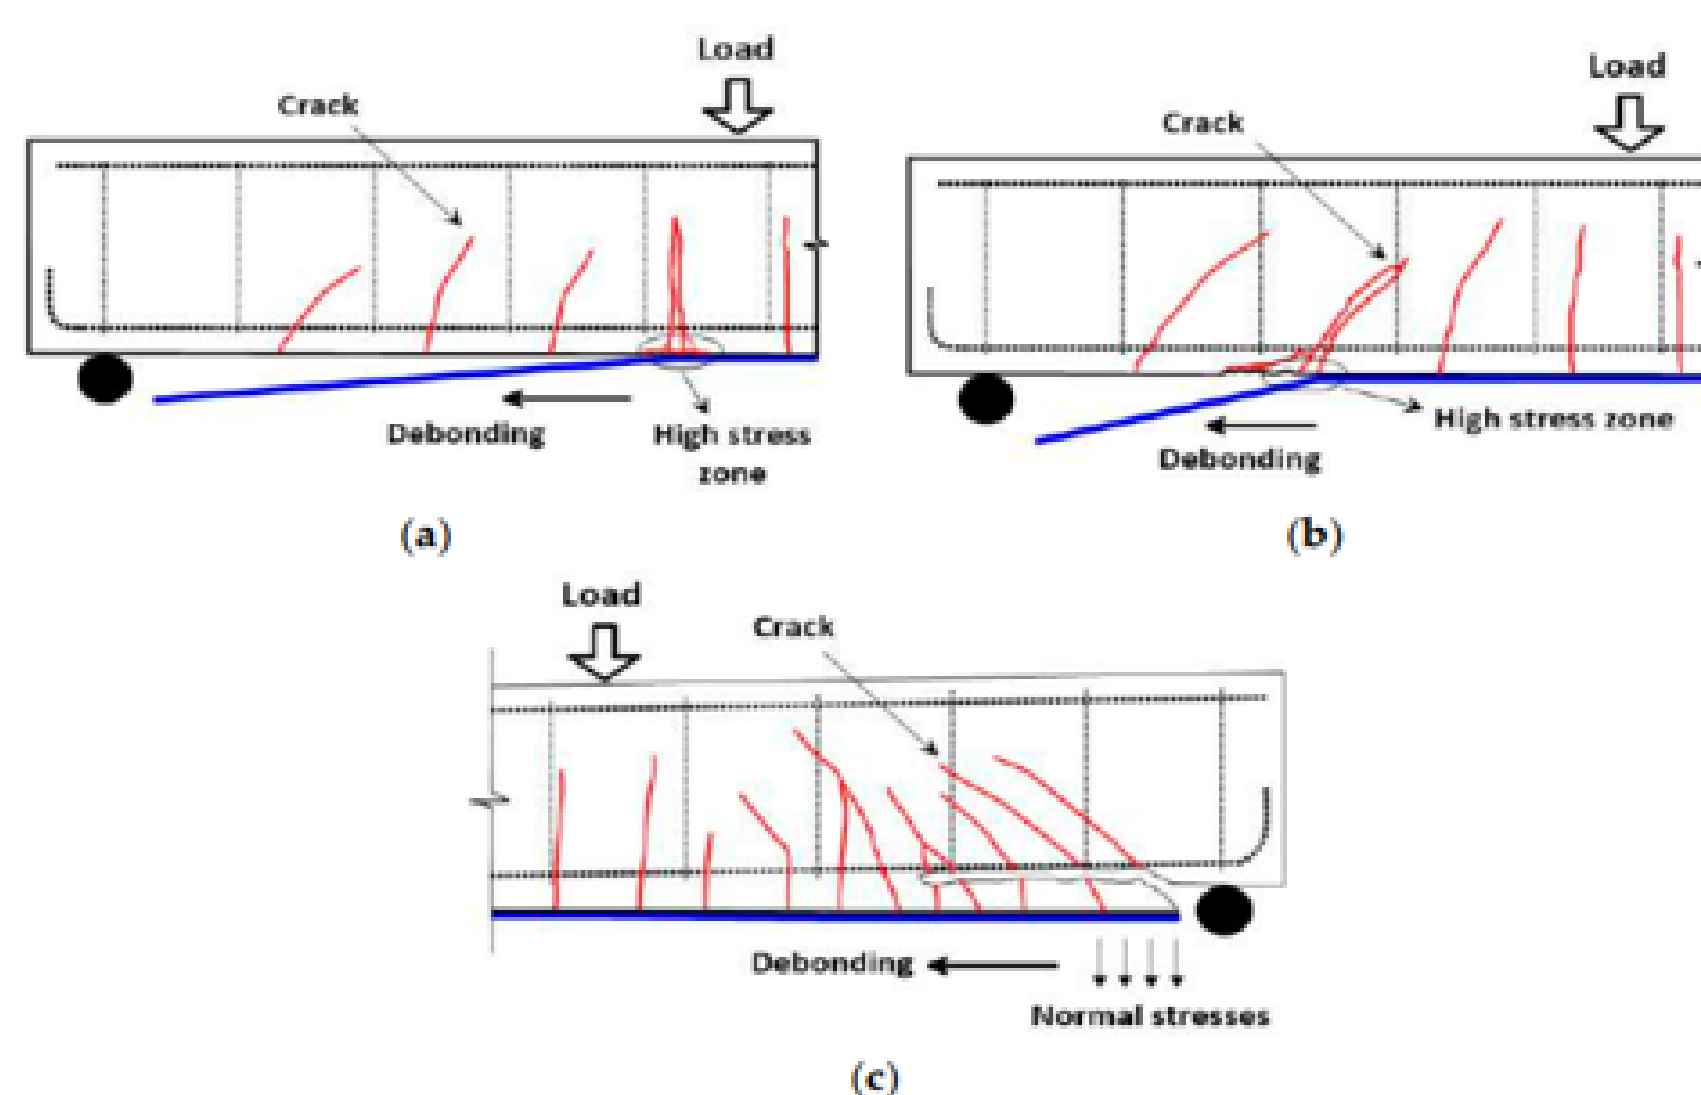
Décollement interfacial béton/FRP induit (a) par des fissures de flexion intermédiaires (b) par des fissures de cisaillement intermédiaires (c) séparation de couverture en béton.
